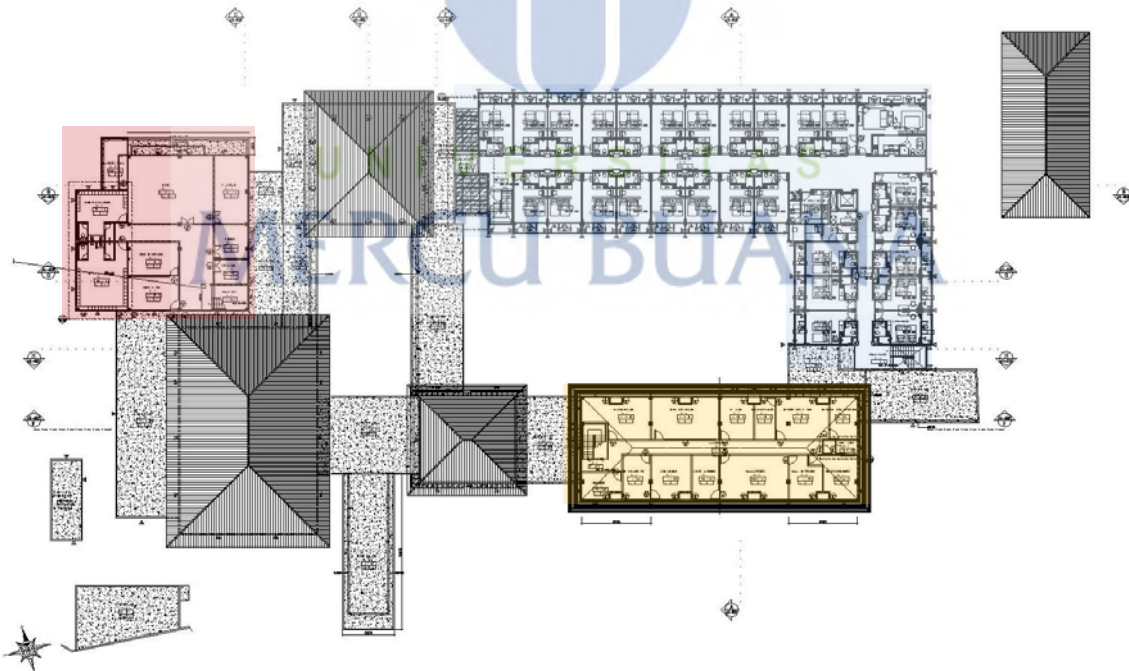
Visualisasi Denah Lantai 1 Dengan Penandaan Ruang
